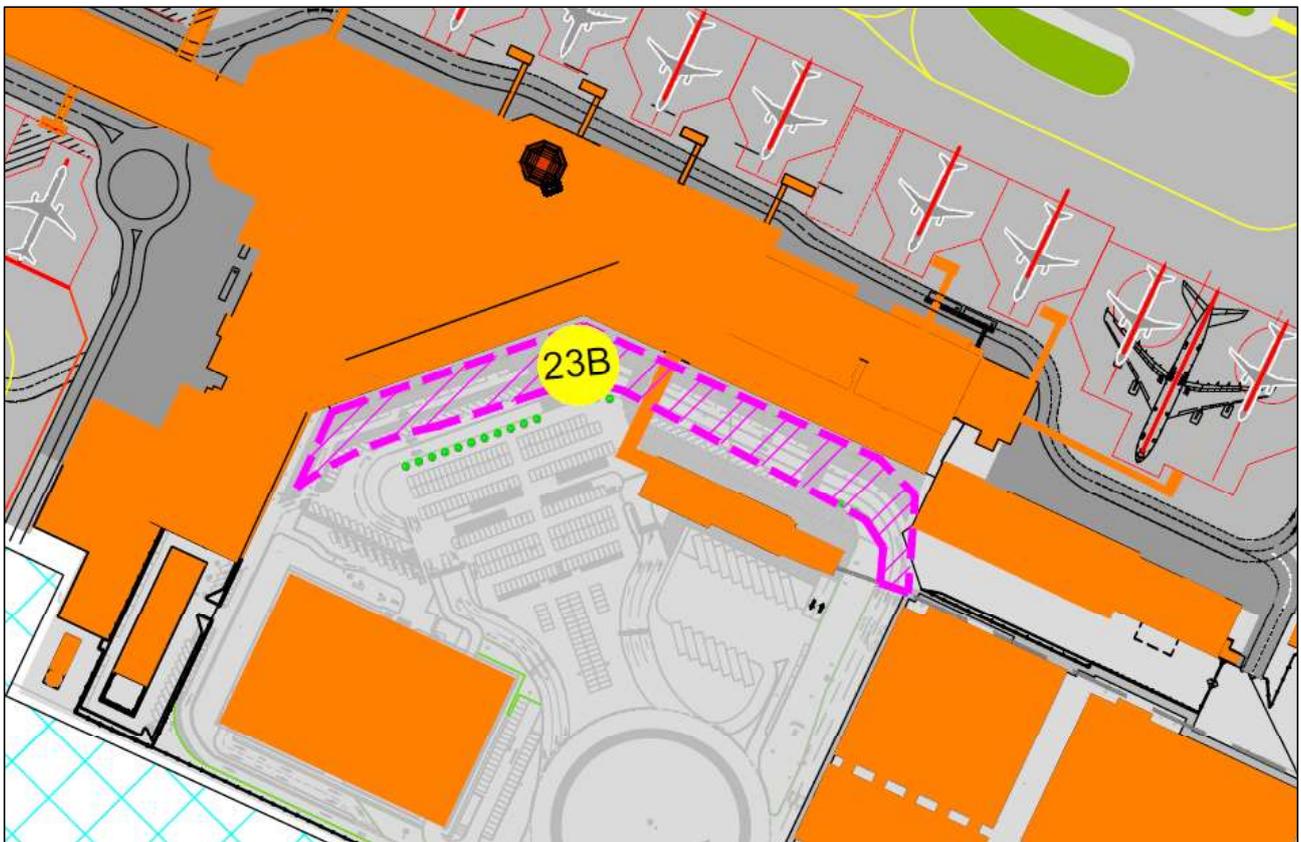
Estratto Master Plan – Nuova Viabilità Fronte Terminal (Curbside)
